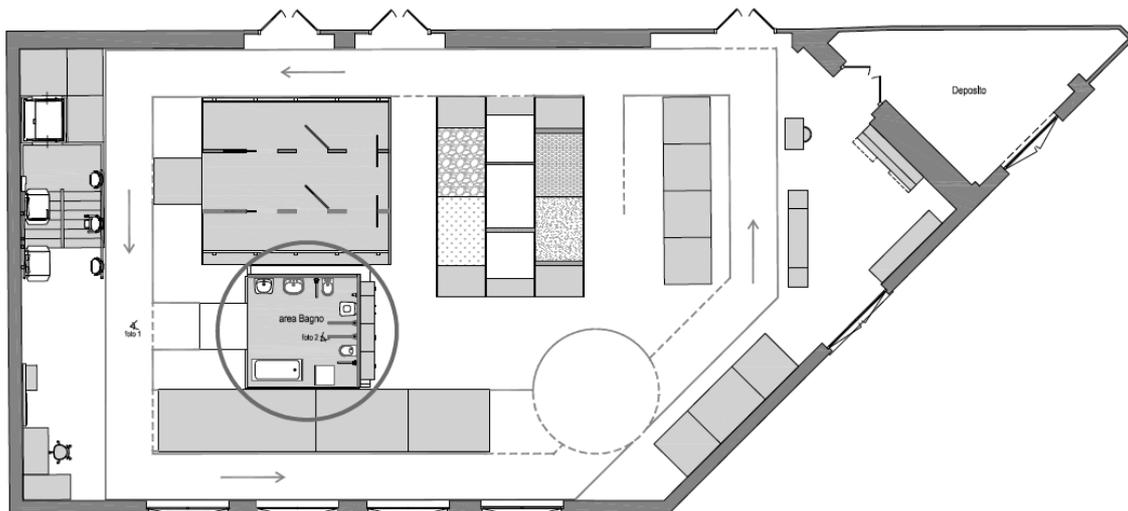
Planimetria Palestra di AUSILIA - Area Bagno
